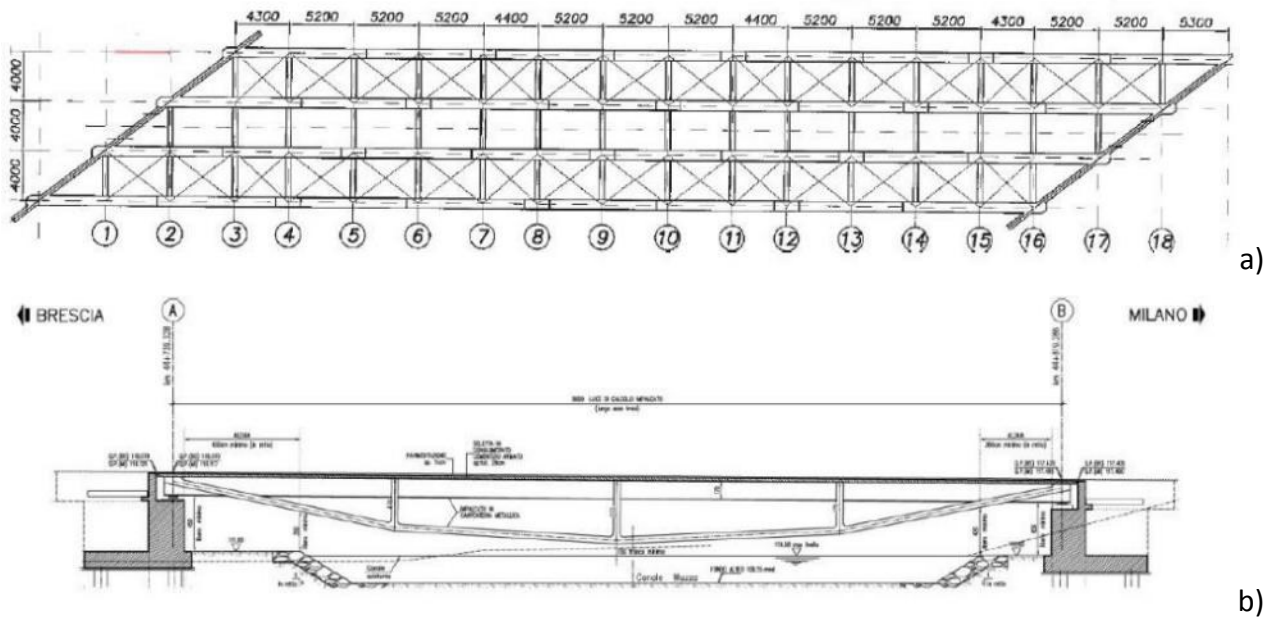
schema costruttivo del ponte Muzza; a) vista dall'alto; b) sezione longitudinale.
